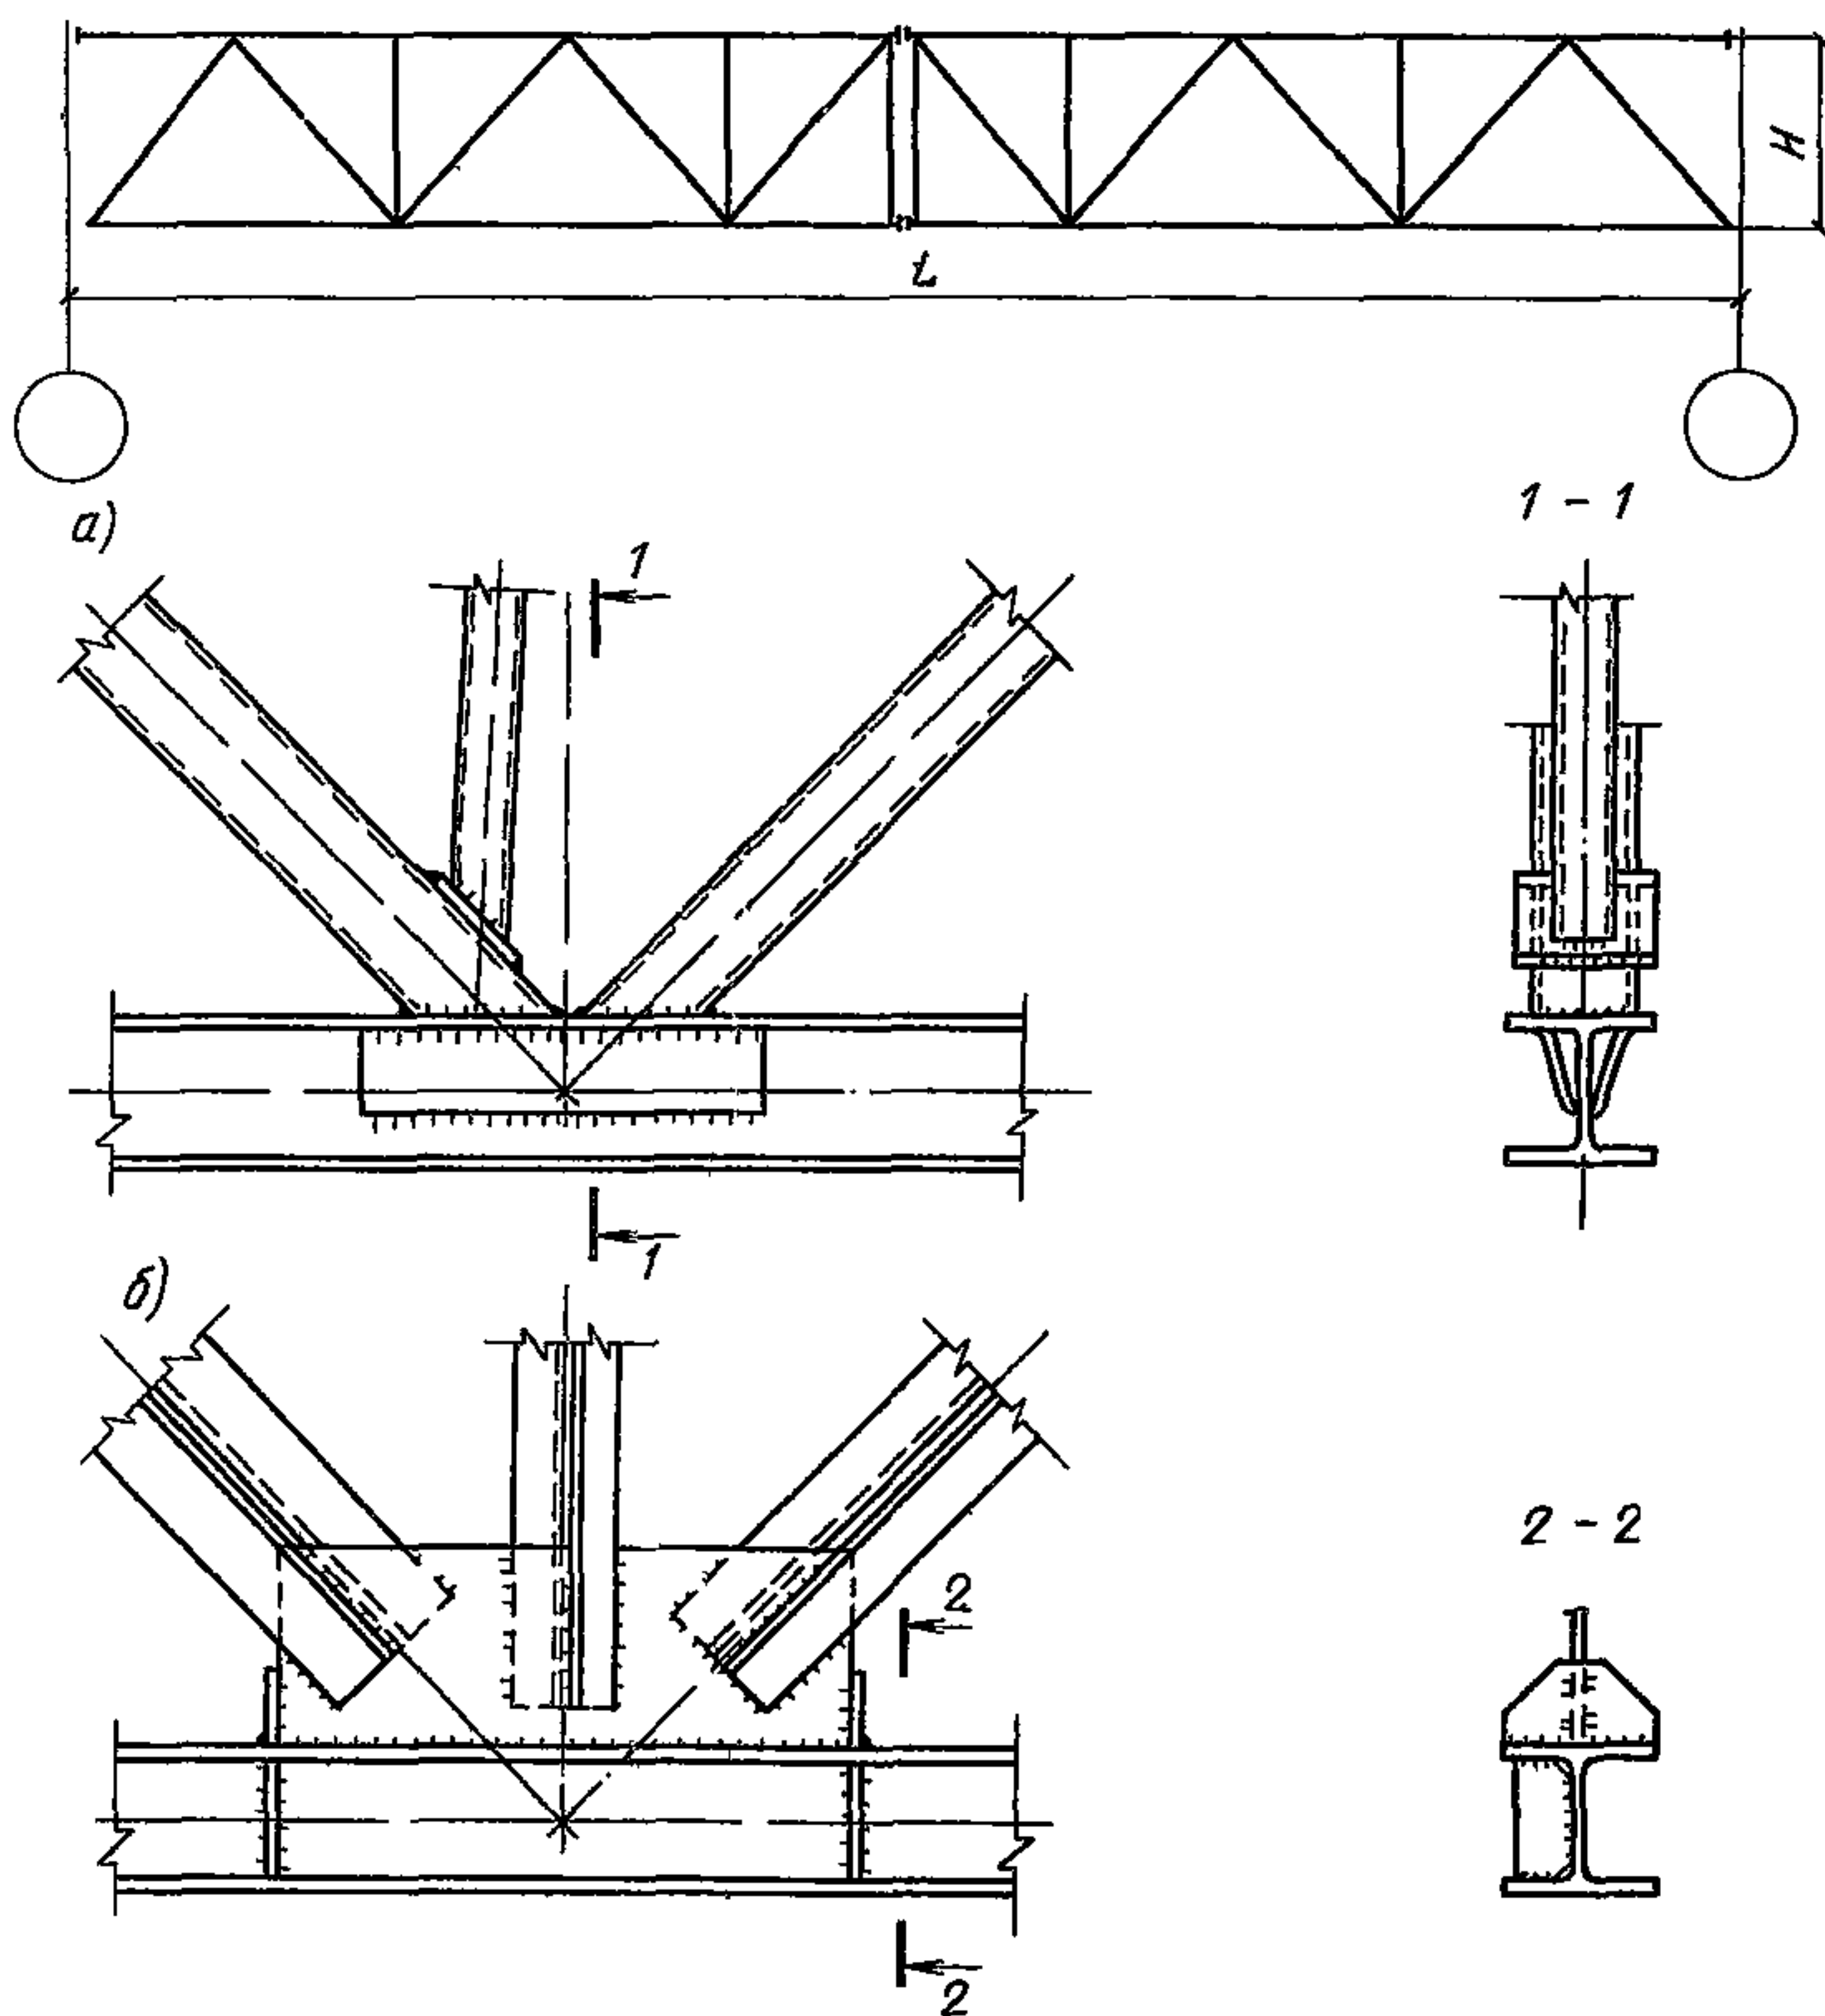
Узел фермы с поясами из вертикально расположенных двутавров
